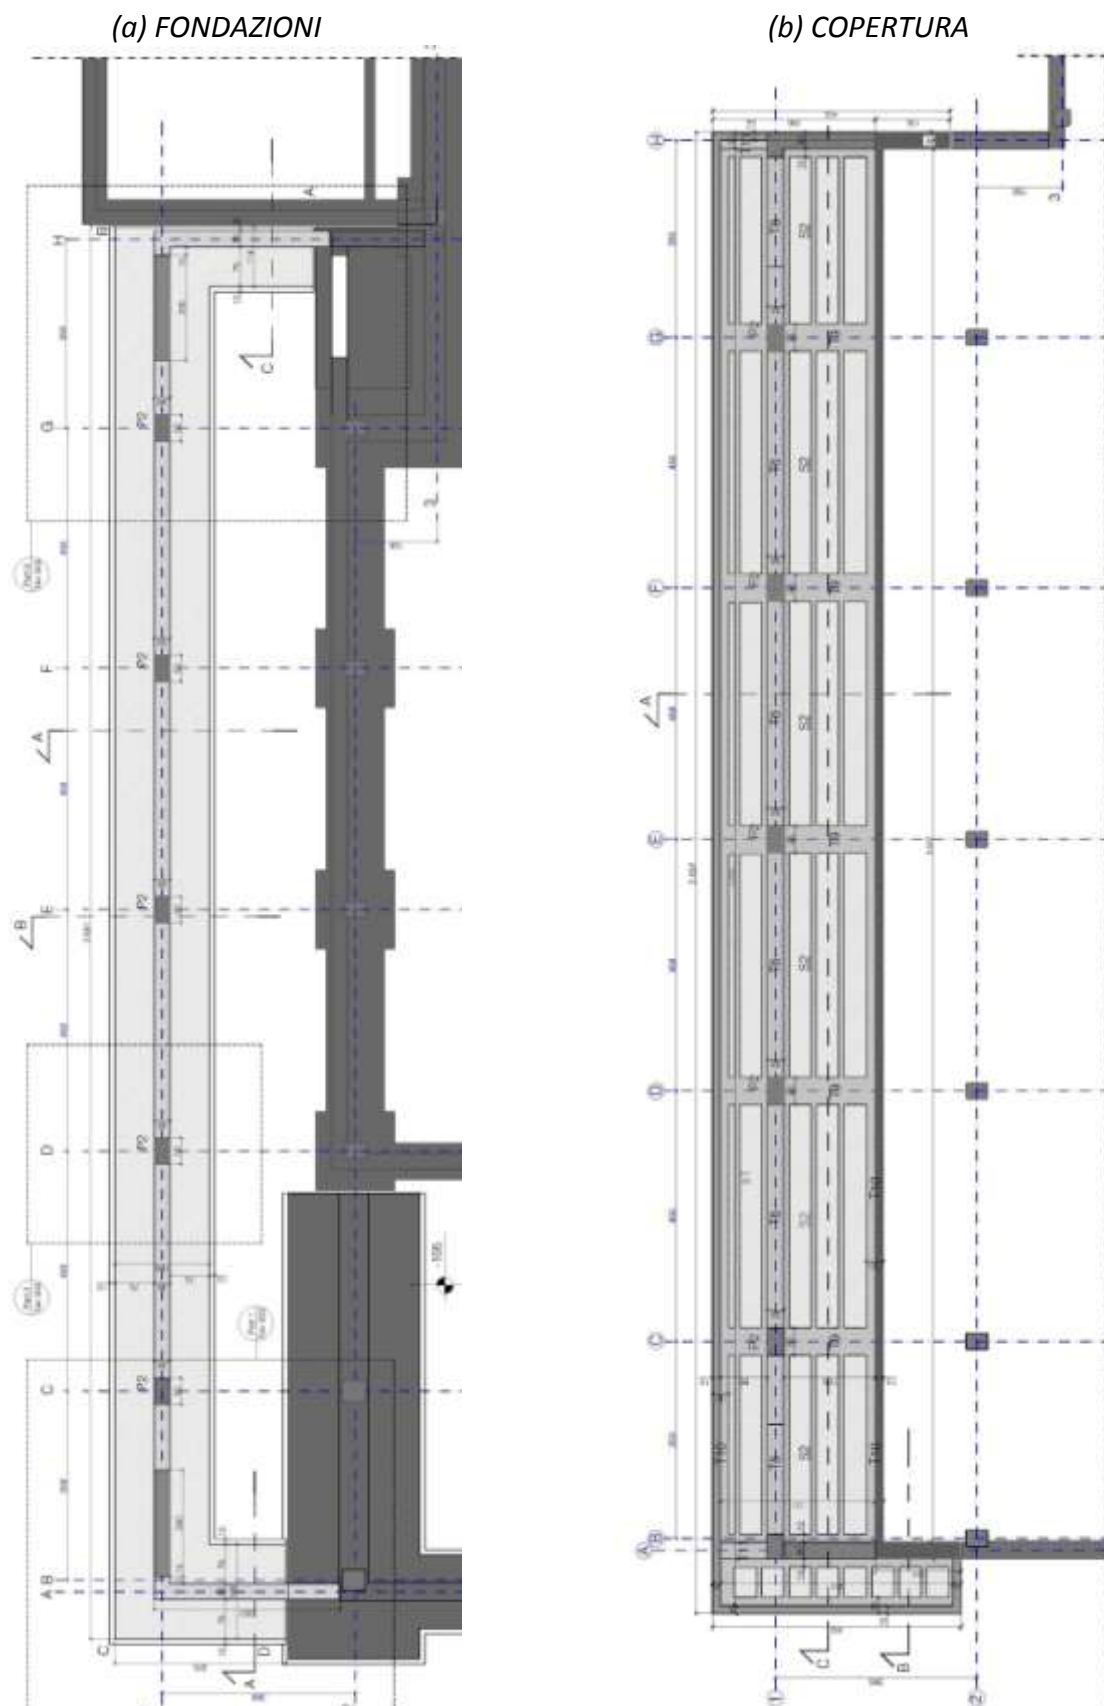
Pianta delle fondazioni (a) e vista speculare della copertura (b).
